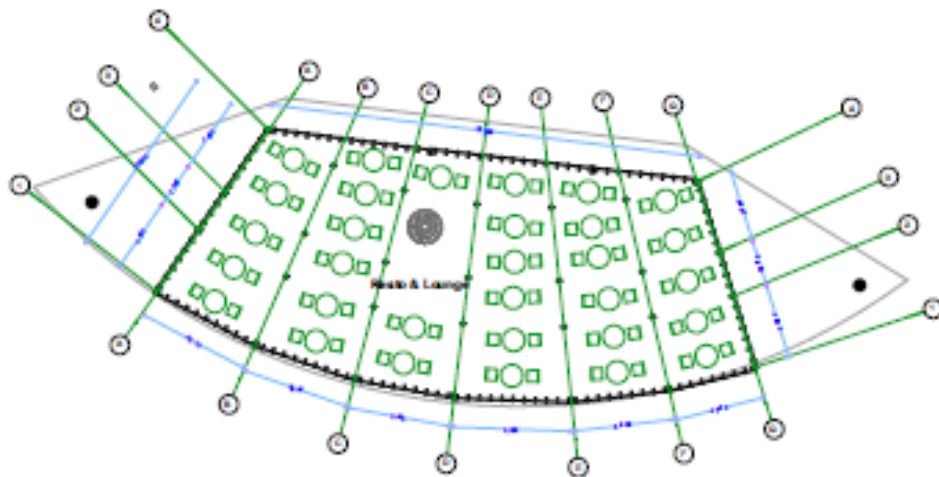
Rancangan Tapak ( Siteplan)
